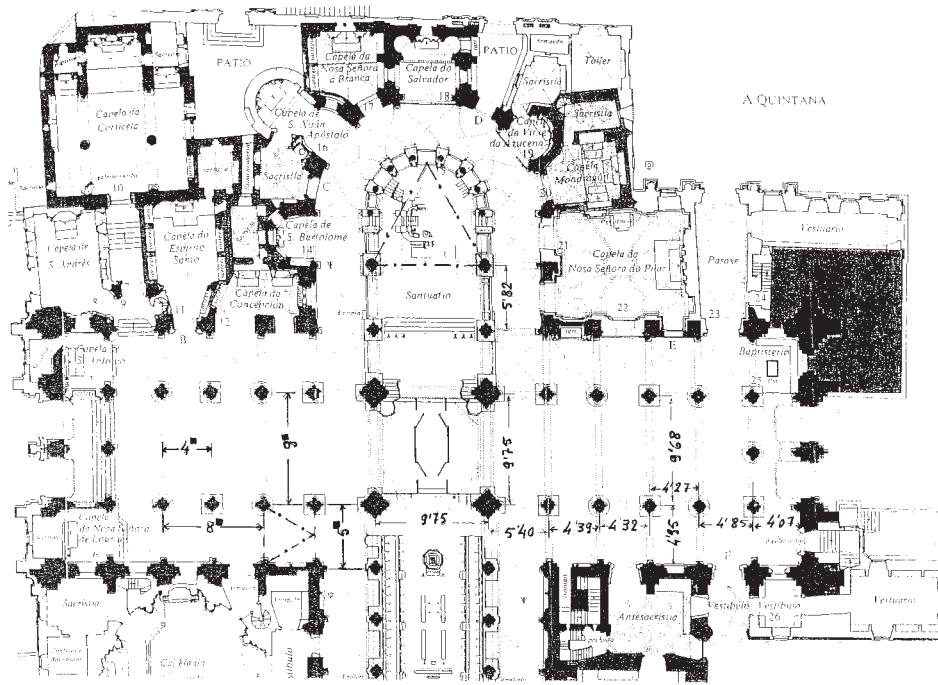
Santiago de Compostela. Módulos sobre la planta de Conant.
